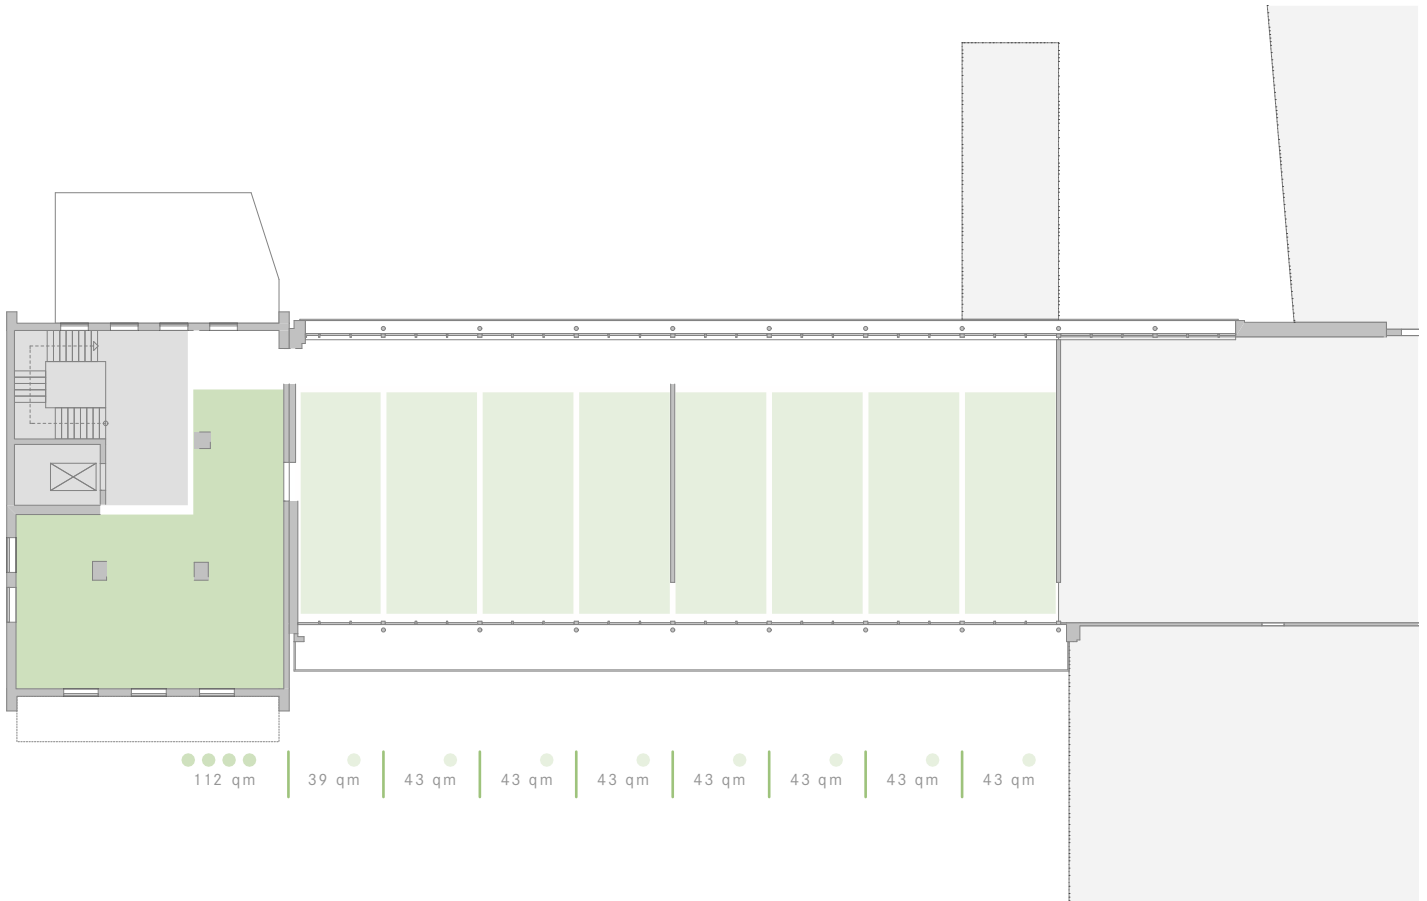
Grundriss Umbau - Wohnungsaufteilung
